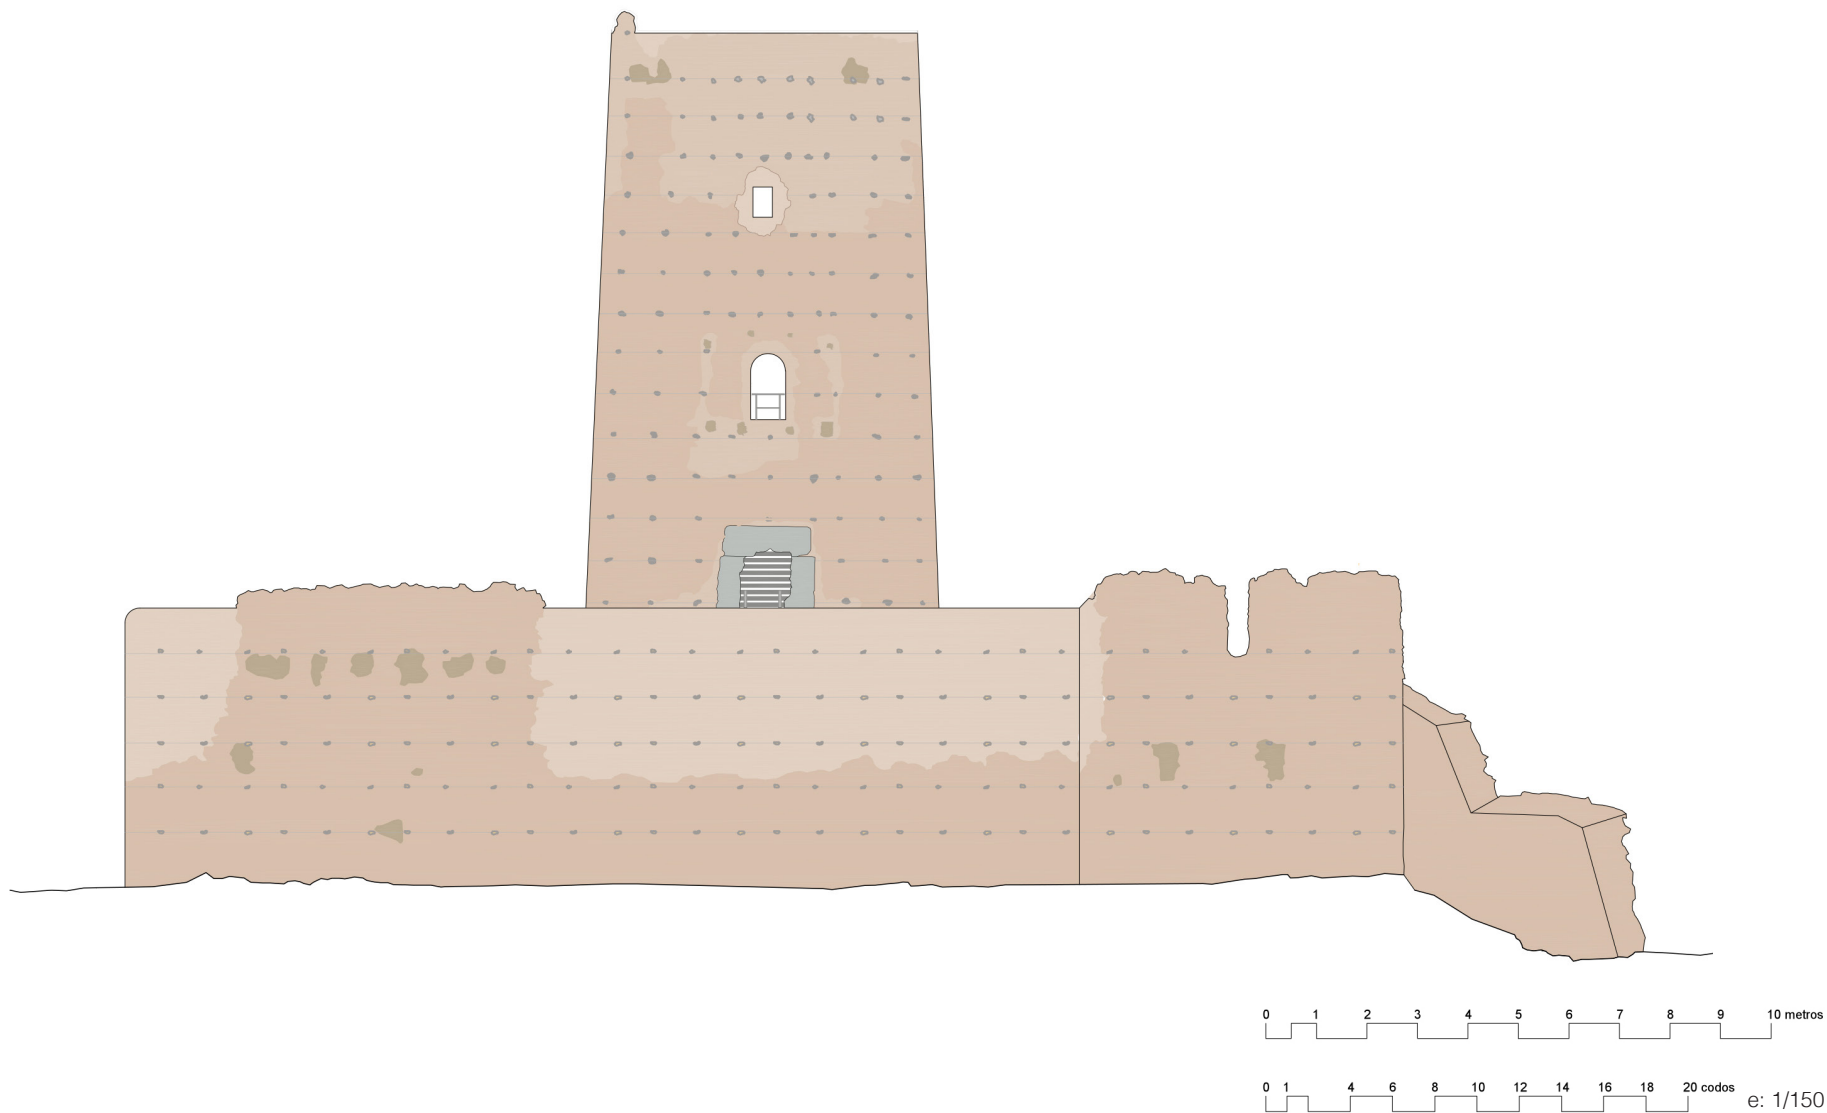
Alzado Sur intervenido. (Elaboración propia)
